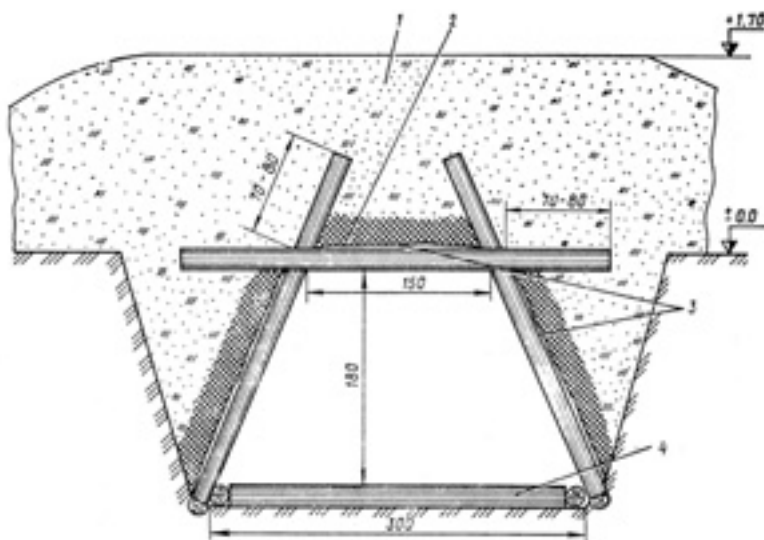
Быстровозводимое ПРУ: 1 – насыпной грунт; 2 – амортизационный слой; 3 – гидроизоляция; 4 – распорная рама
